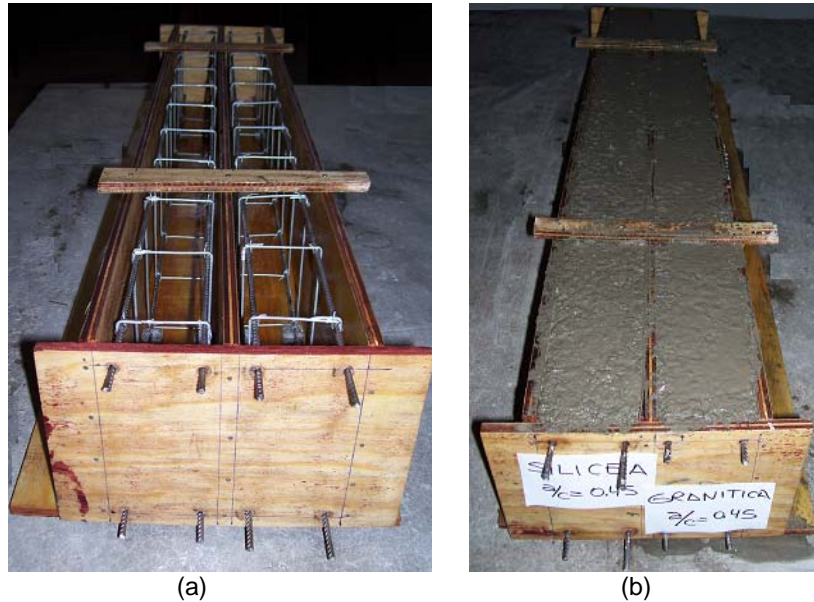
Disposición de la armadura en los encofrados (a) y vigas recién moldeadas (b).
